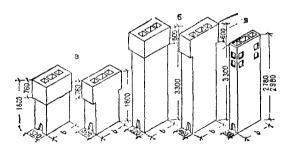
Бетонные вентиляционные блоки a - наружные для зданий с бесчердачными крышами; b - то же, с холодным чердаком; b - внутречние
